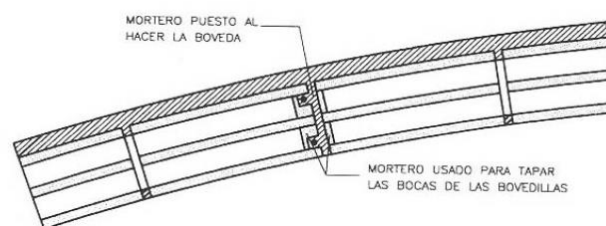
Sección de la ubicación del armado y el mortero entre las piezas cerámicas. Fuente Eladio Dieste (1943 – 1996)
